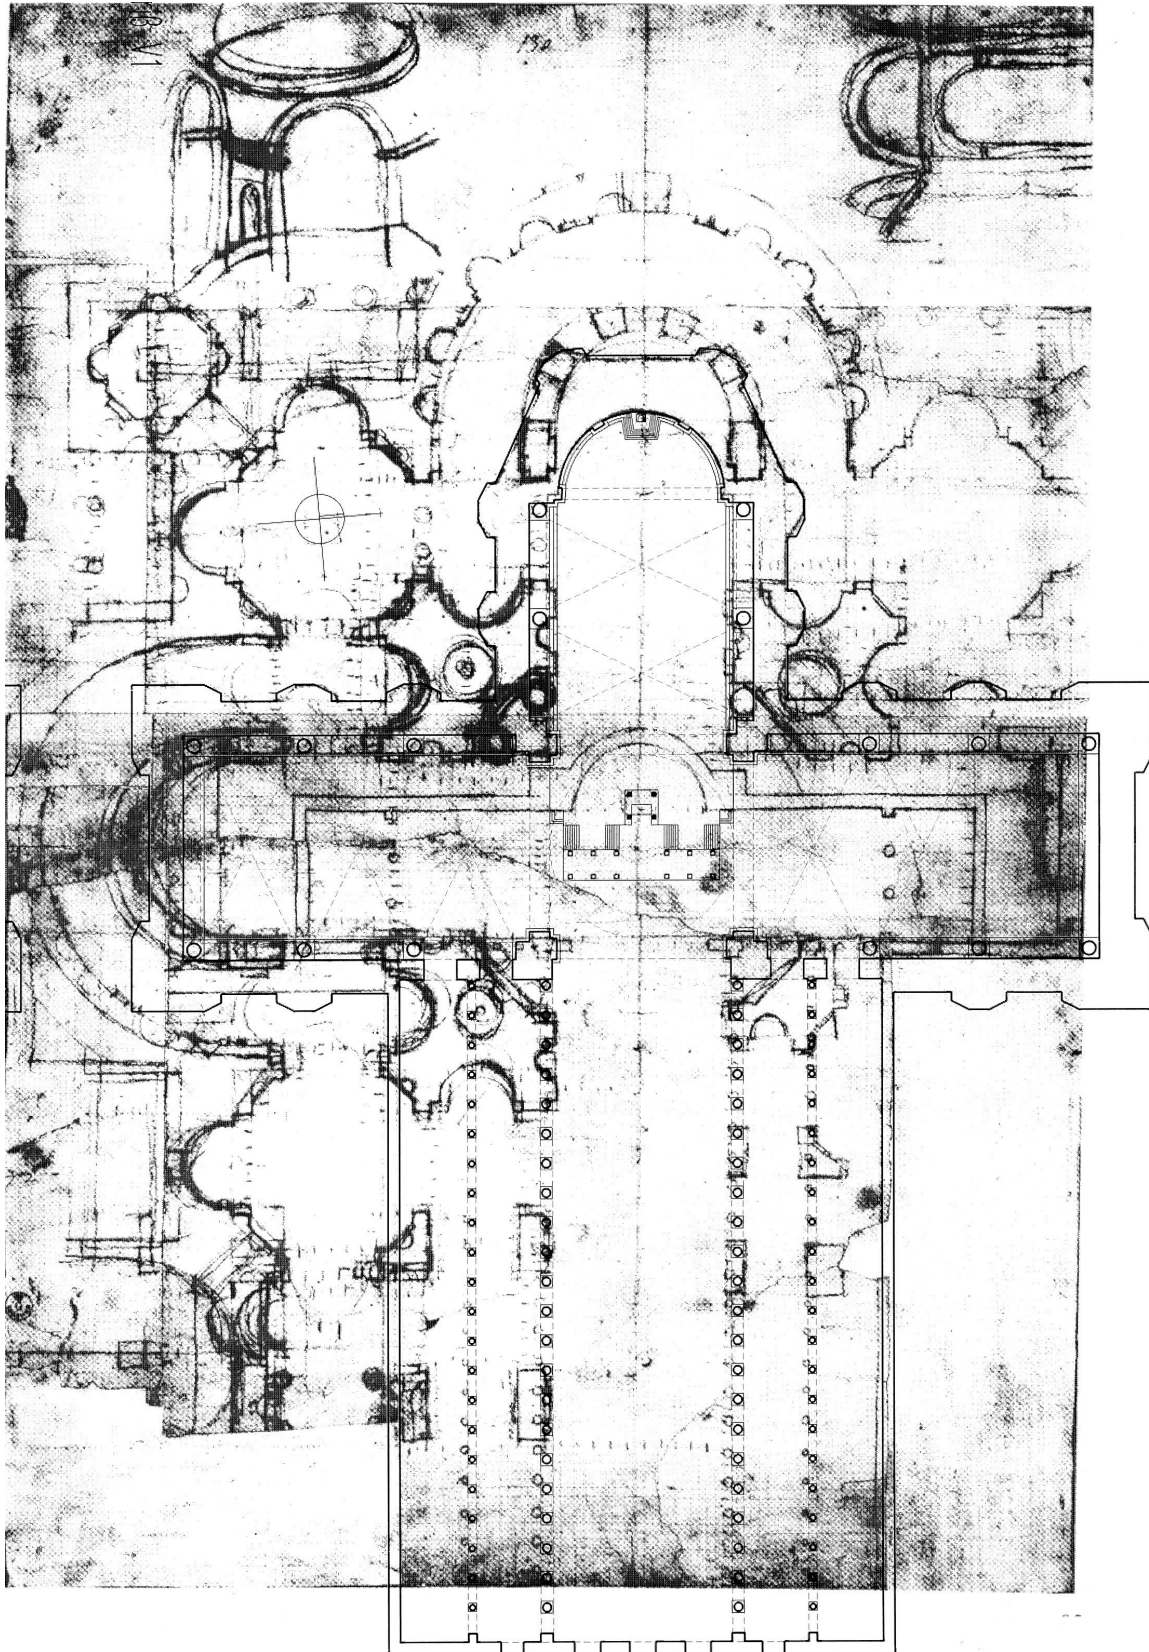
Florenz, Uffizien A 20, mit rekonstruierter Grundrissvariante 1 des Rosselinoprojektes.
